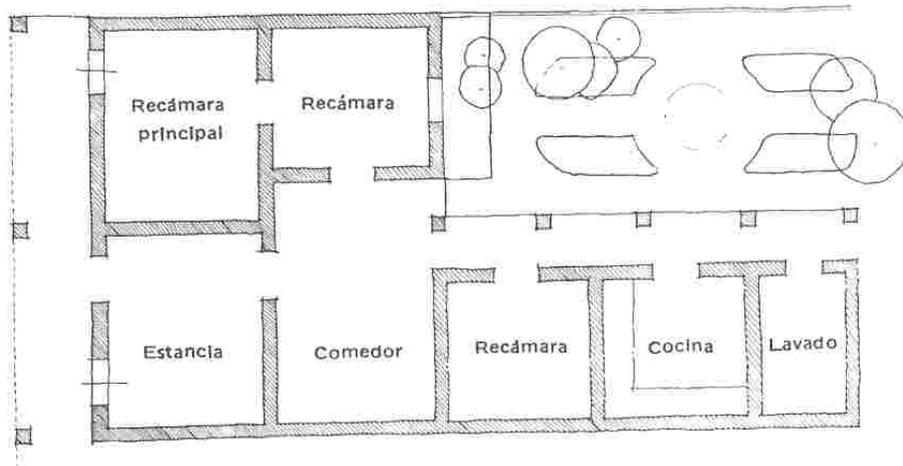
Planta arquitectónica de una casa tlacotalpeña.
